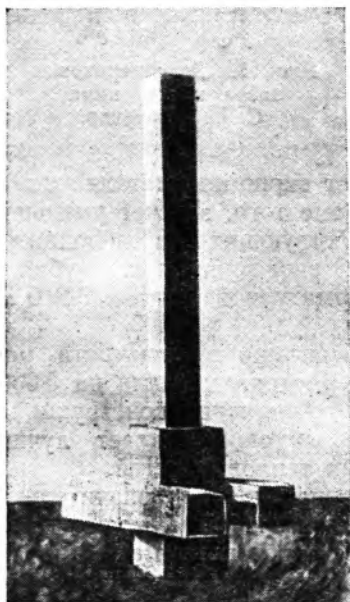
Общий вид сборного железобетонного фундамента для промежуточных опор линий электропередачи.
